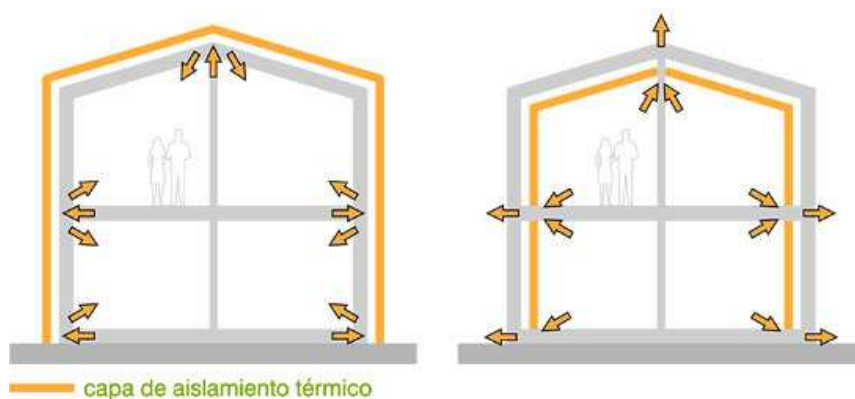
Vivienda con y sin aislamiento. Fuente: <https://www.google.es/search>
